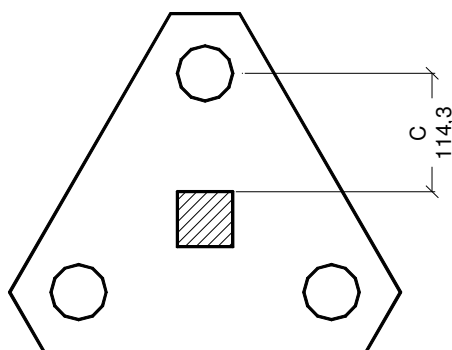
Distância da face do pilar ao centro do fuste mais afastado.
